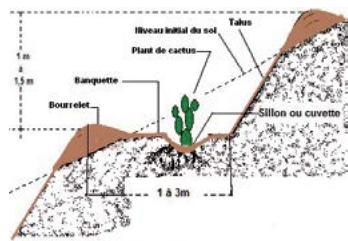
Coupe transversale d'une banquette aménagée pour la plantation du cactus sur terrain en pente modérée
